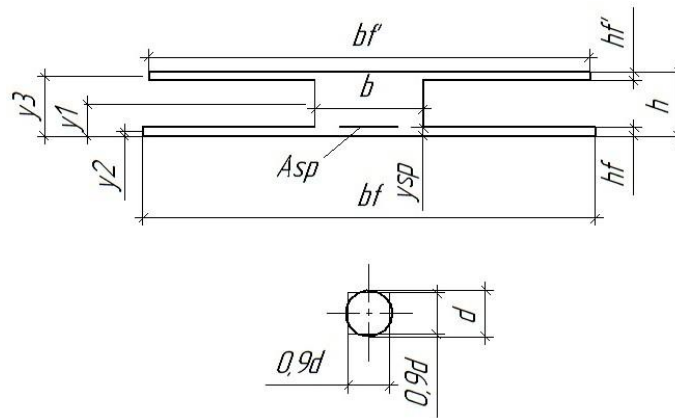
Приведённое двутавровое сечение плиты перекрытия и приведение круглого отверстия к квадратному
